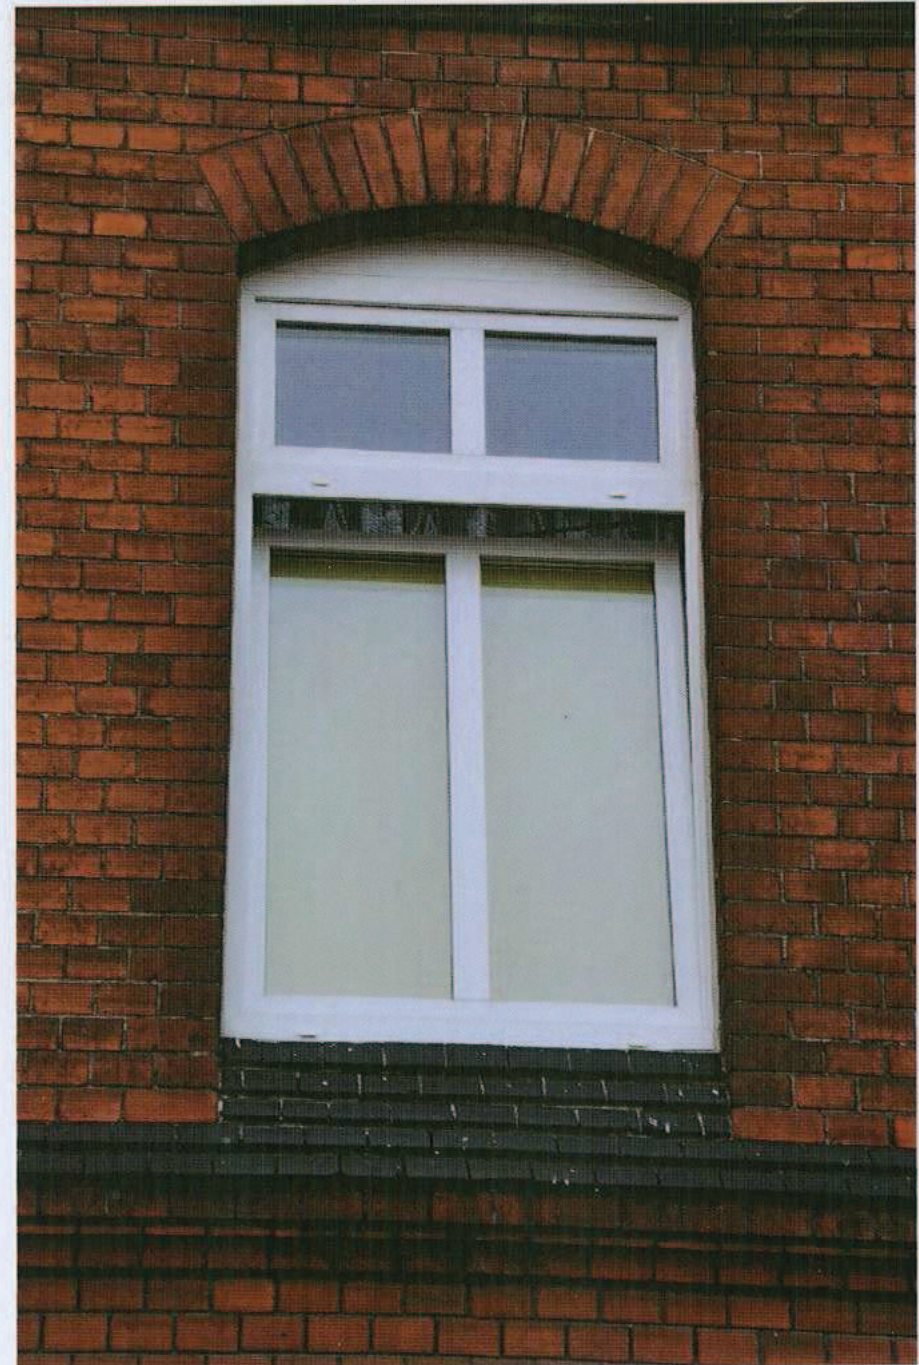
Widok na pierwszą kondygnację – ryzalit elewacji północnej.
